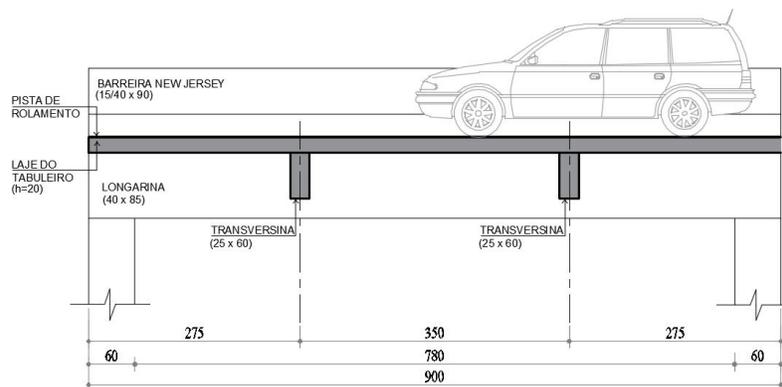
Croqui da seção longitudinal da ponte (medidas em centímetros)
